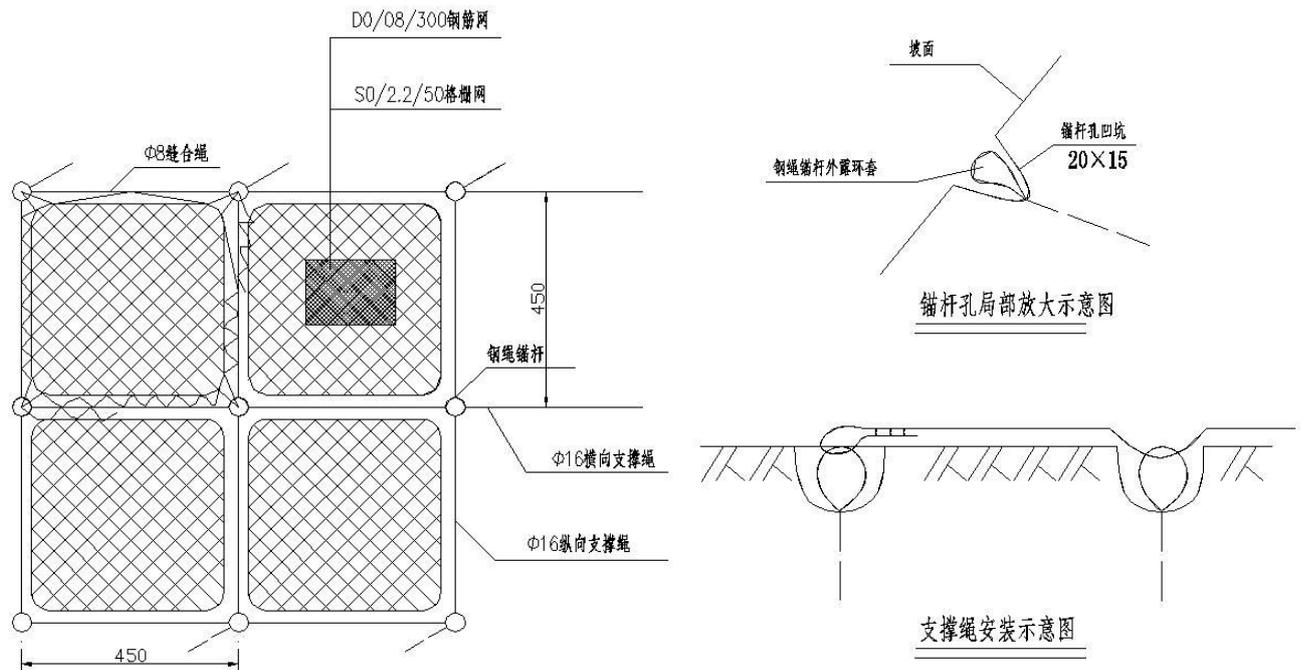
主动防御网系统标准布置及缝合示意图（单位：mm）
